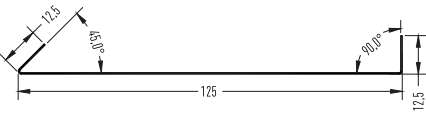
• Fugenhinterlegung (mechanisch befestigt)
